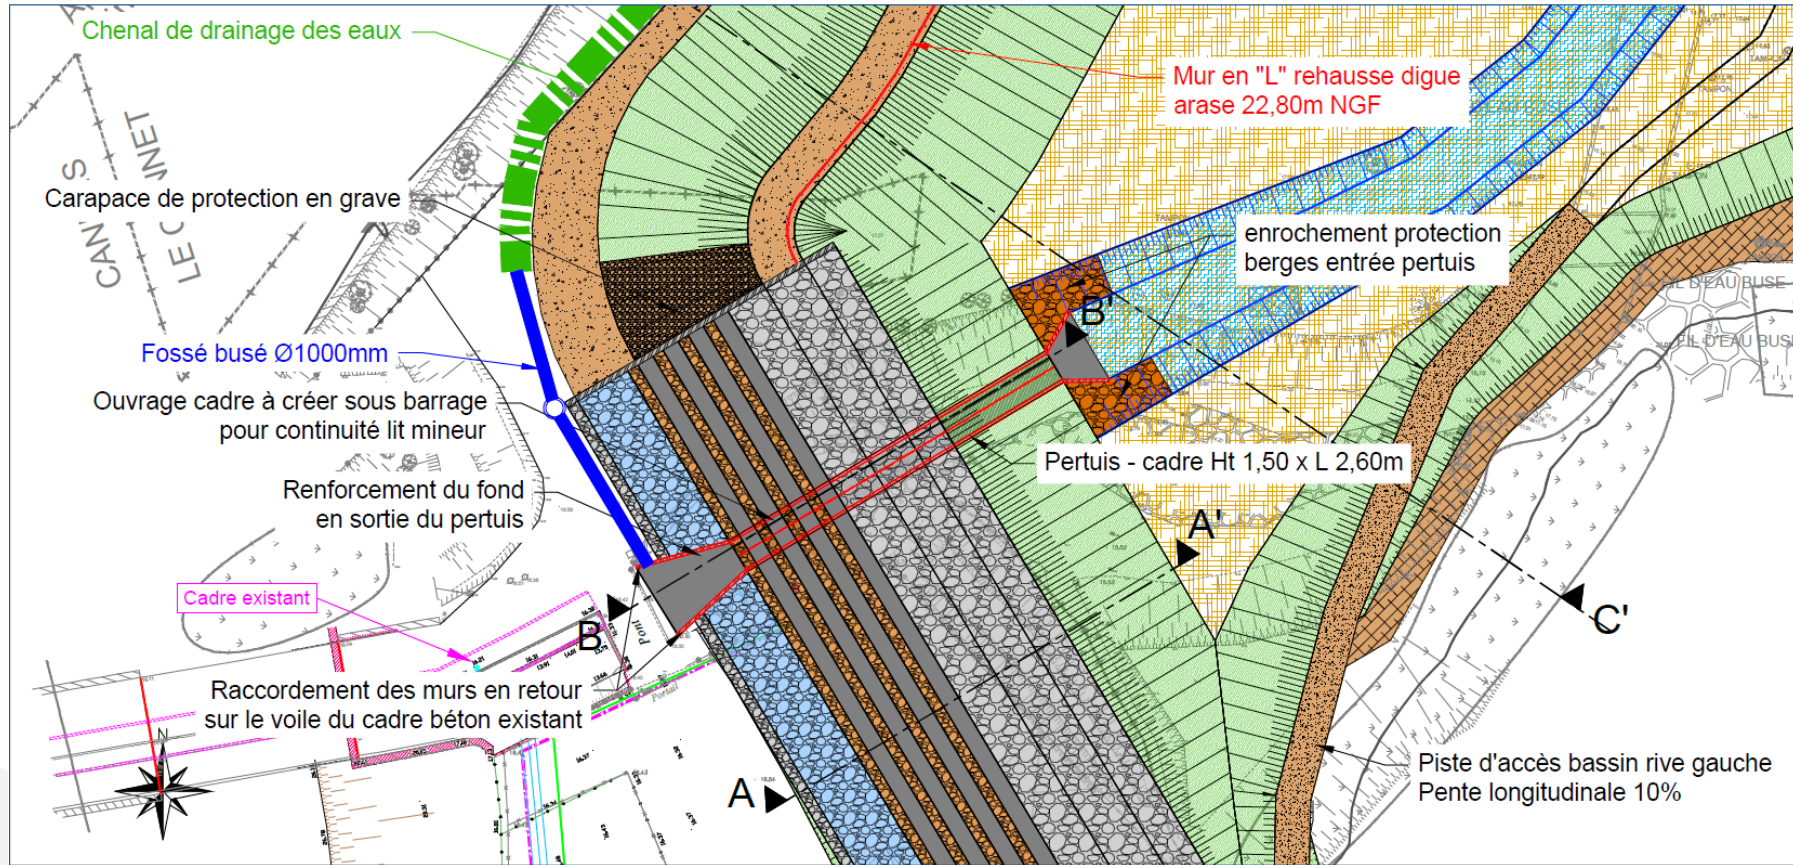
Plan détaillé du pertuis de fond – plan AVP
